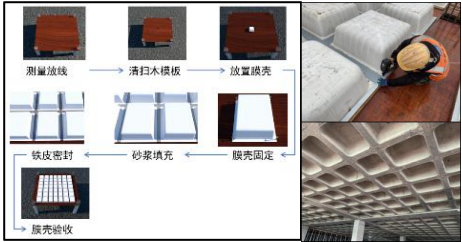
现浇钢筋混凝土密肋楼盖施工工艺
